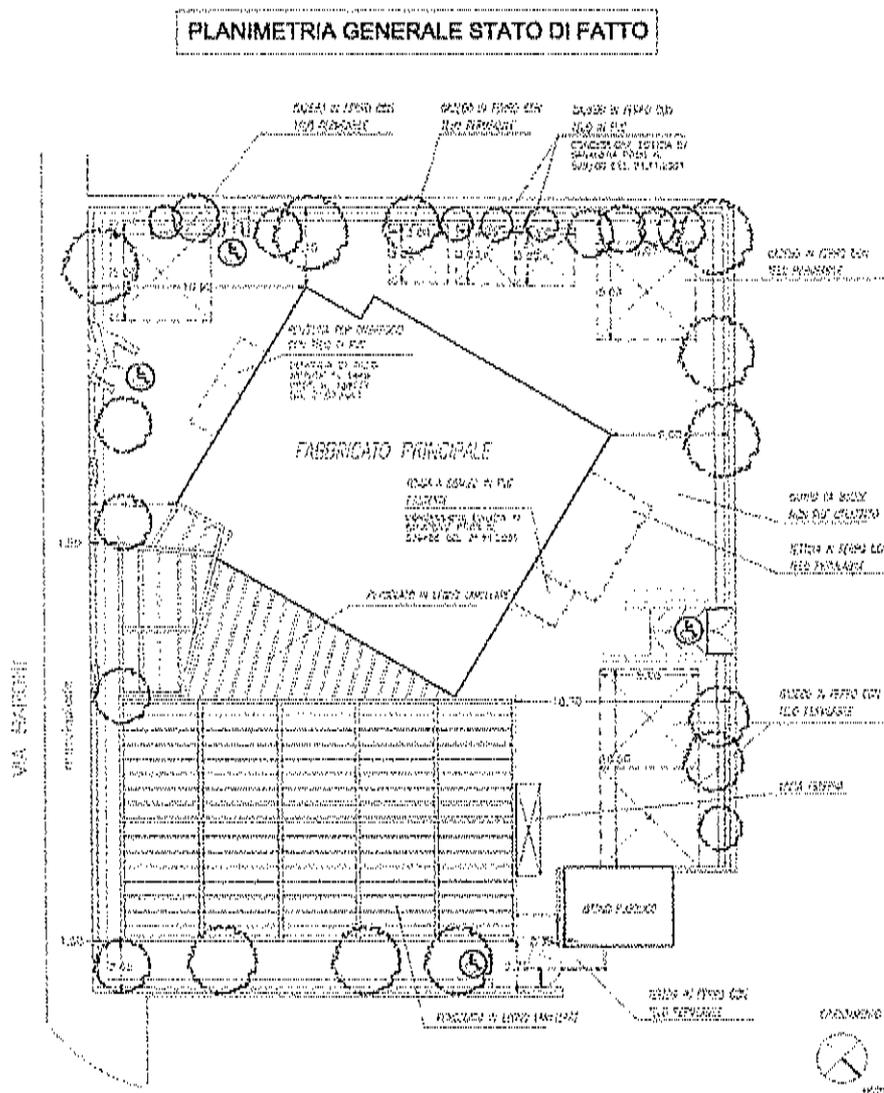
Planimetria generale del centro sociale di Viserba Via Baroni n. 9
